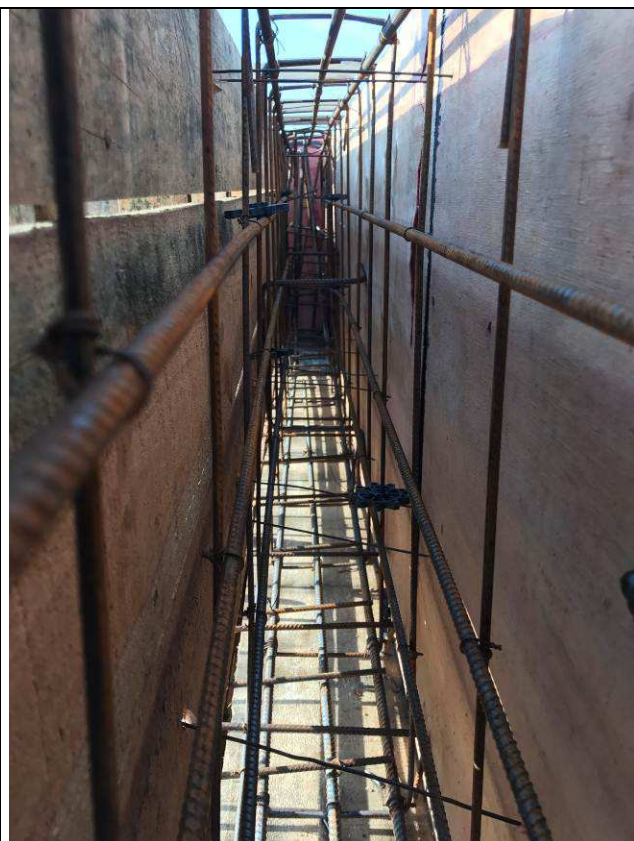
C: Formas e armaduras das vigas e lajes da guarita.
